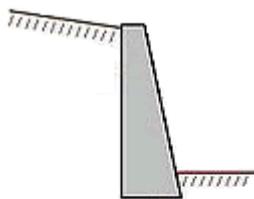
Modelo de muro Muro com Arrimo de arrimo.
